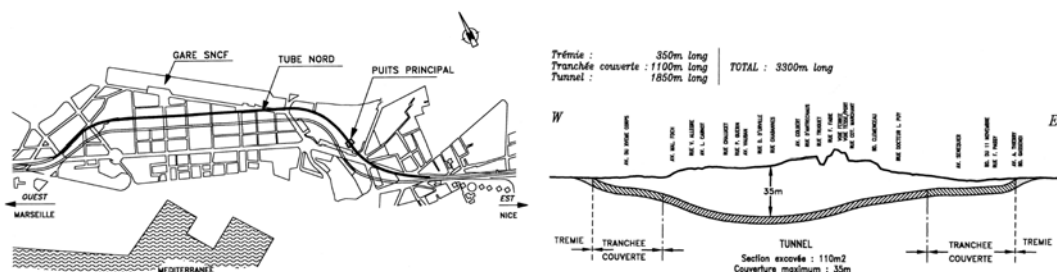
23 – planta da cidade de Toulon com a travessia subterrânea e perfil longitudinal (Dias, 1999)
